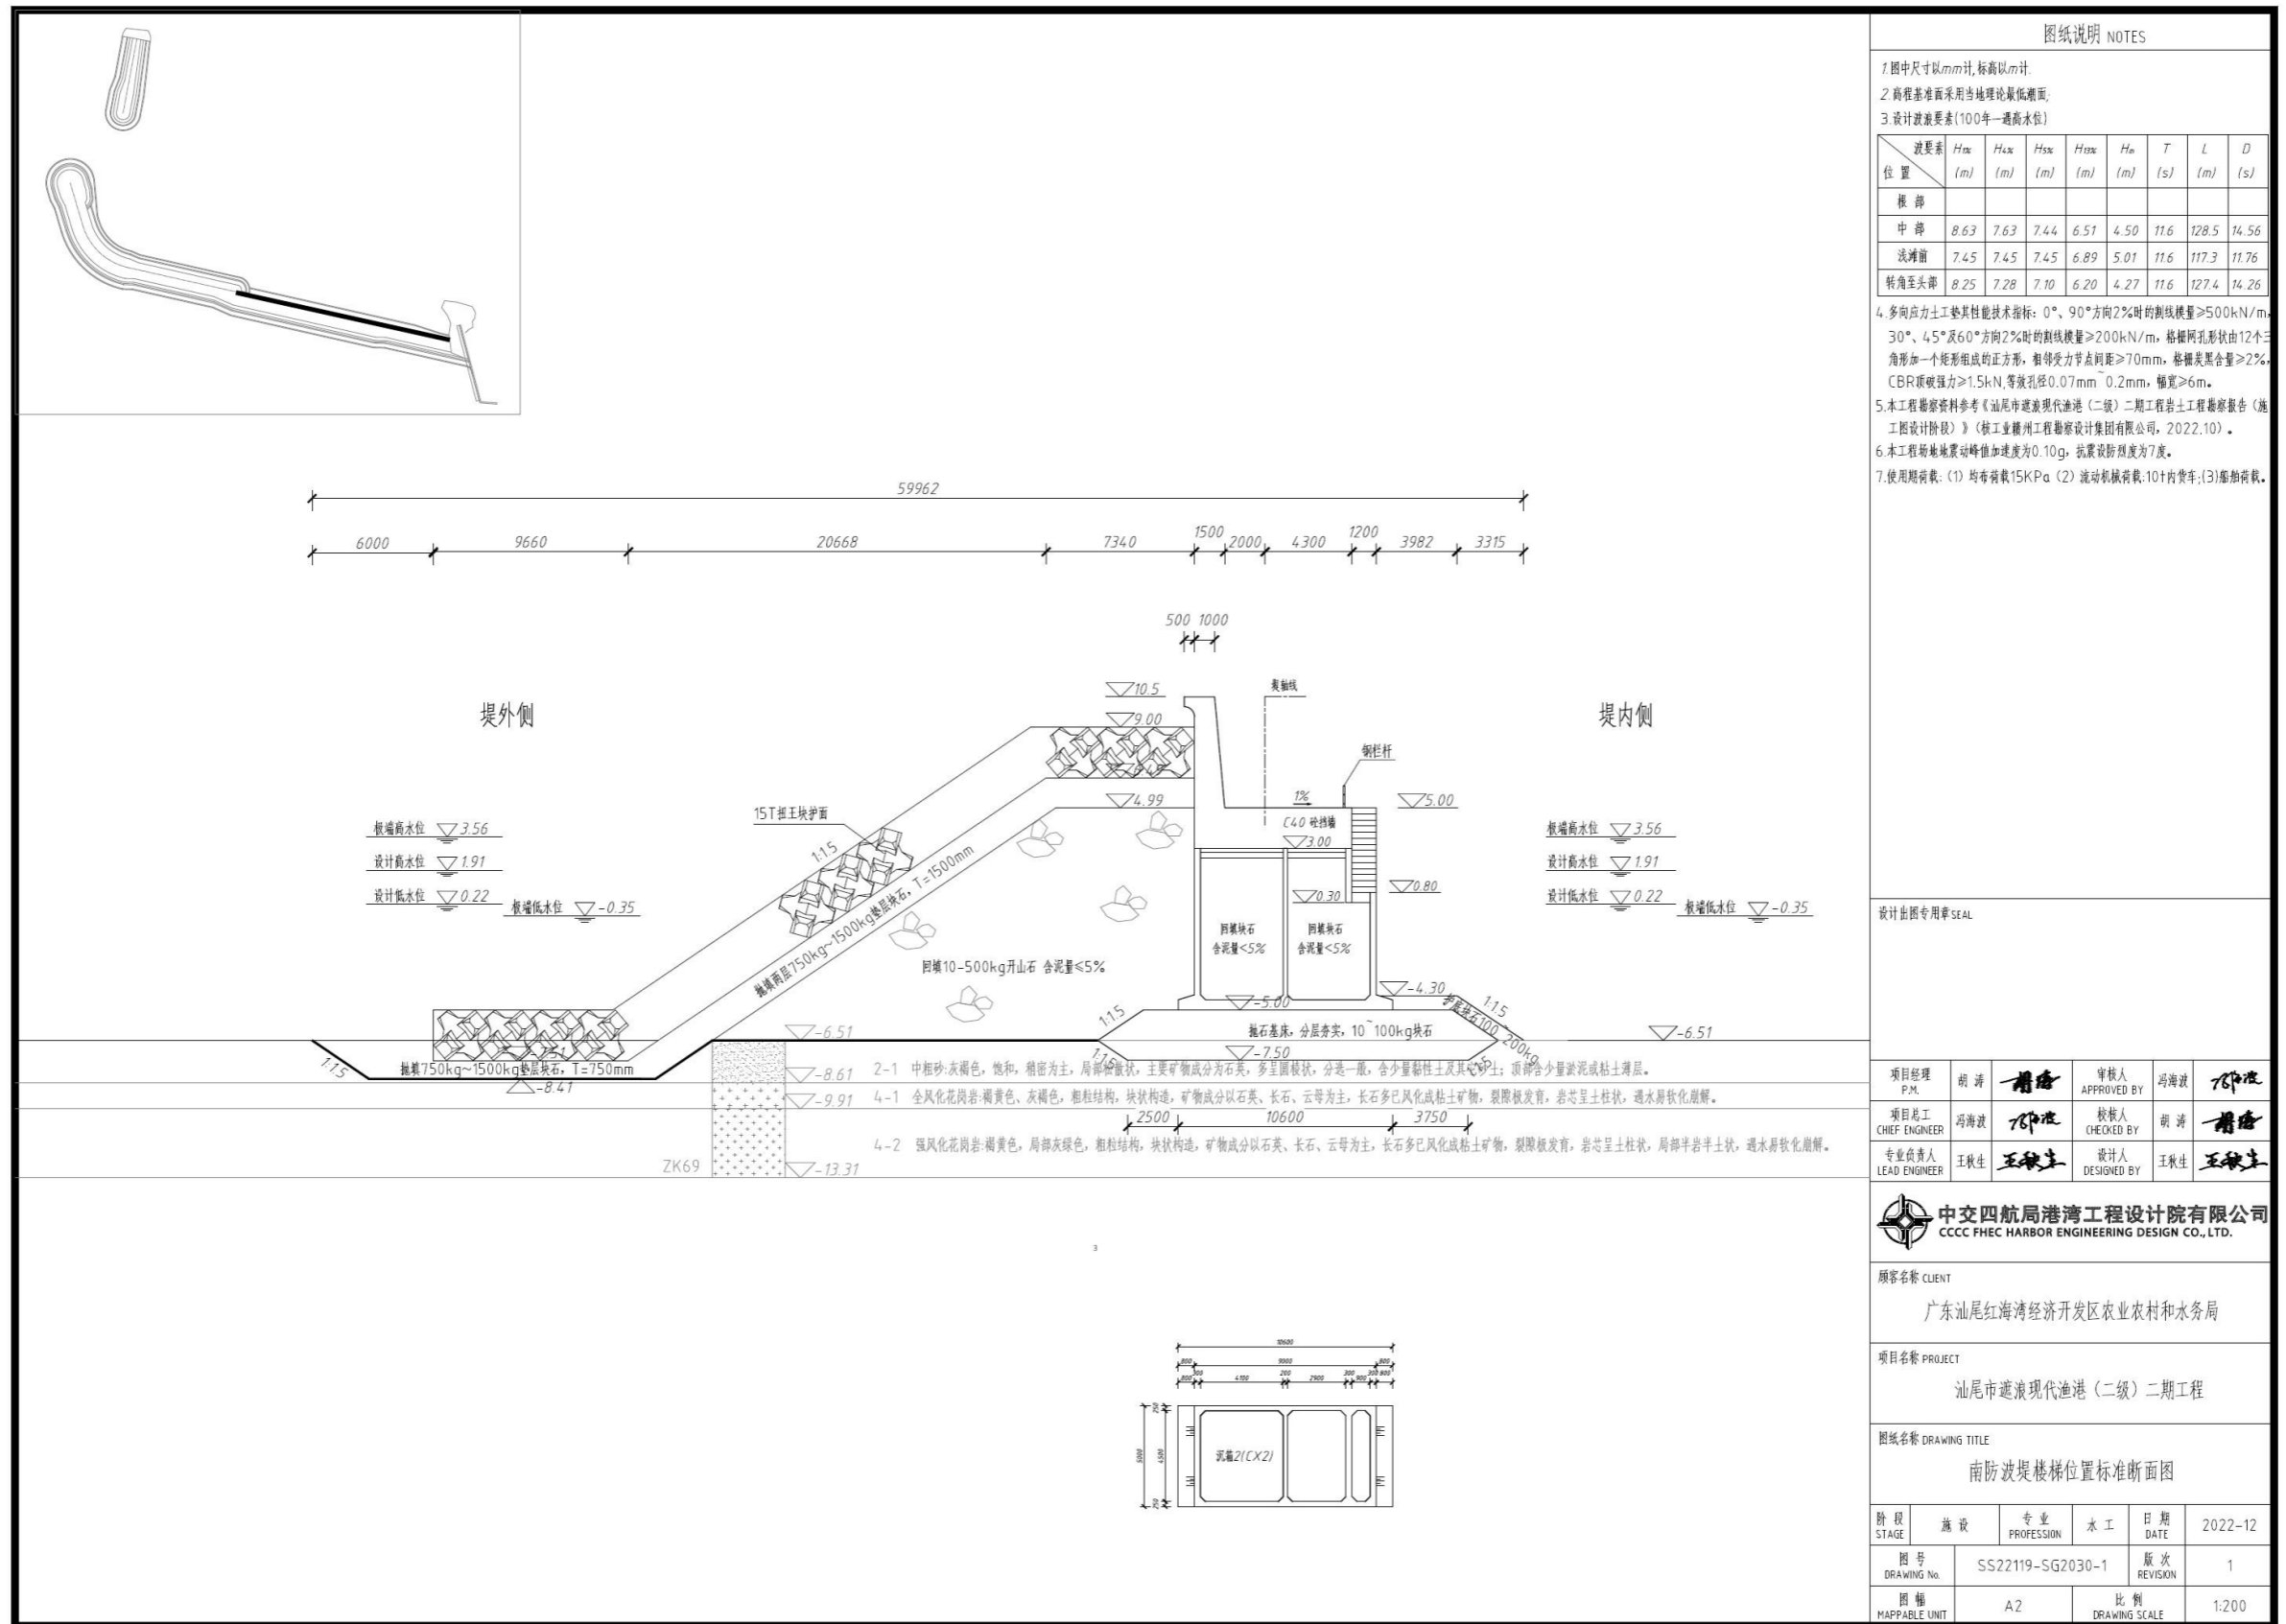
防波堤楼梯位置标准断面图
